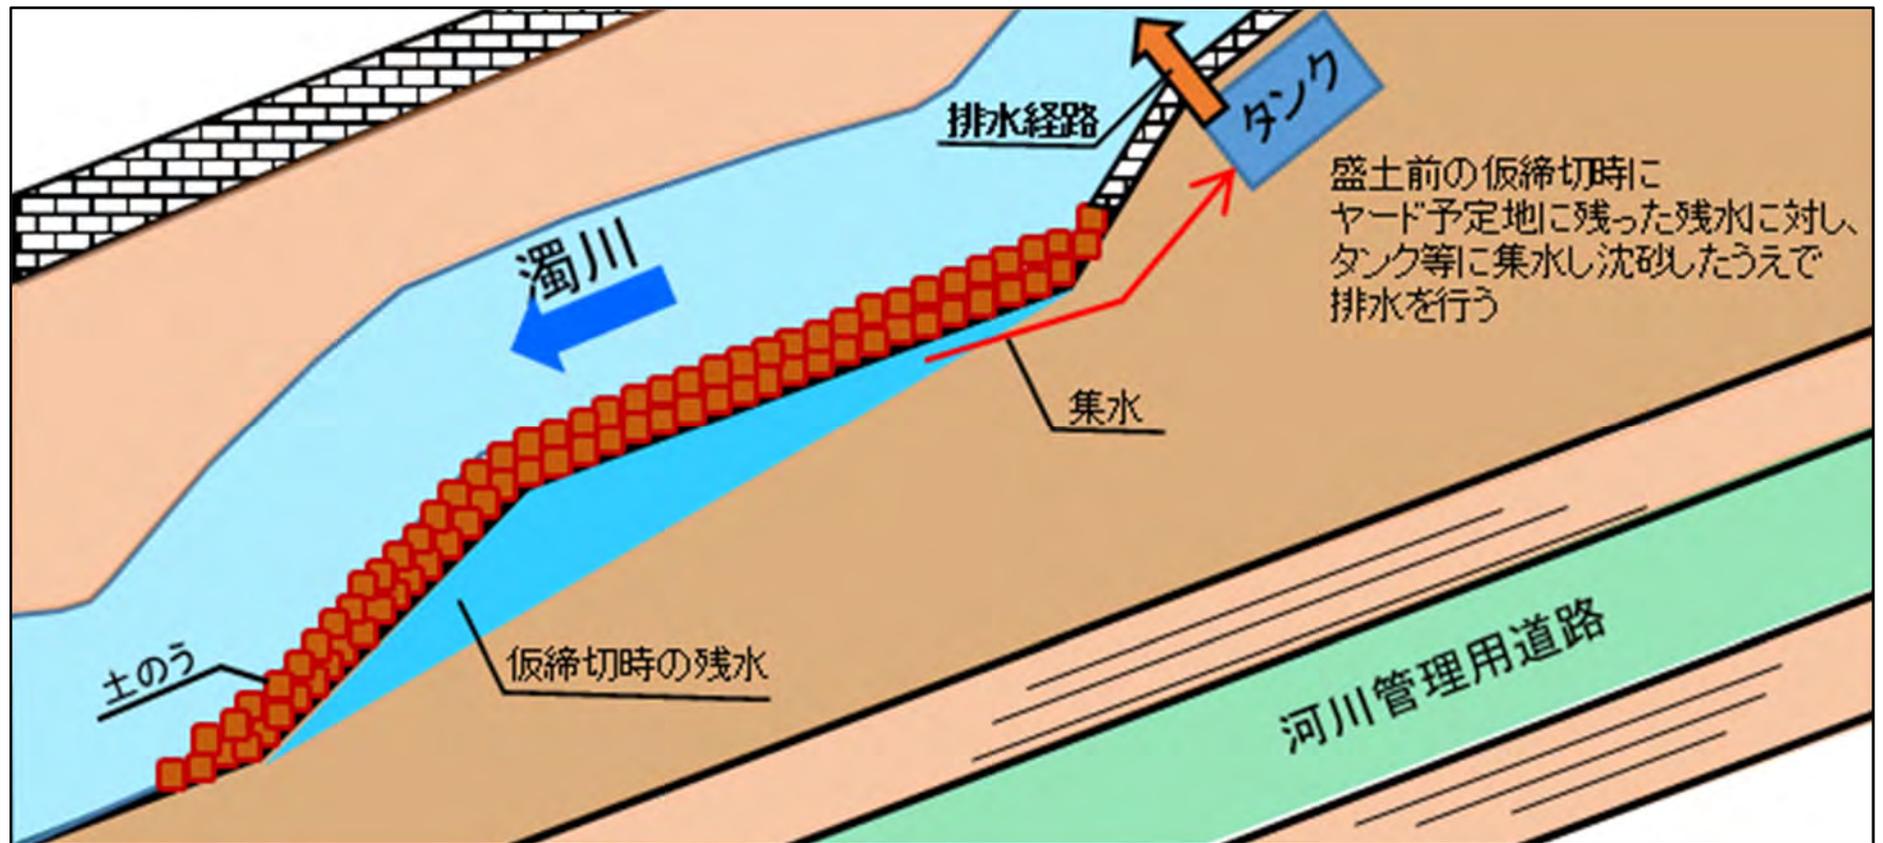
(3) 工事施工ヤード設備配置図 (濁川左岸)
